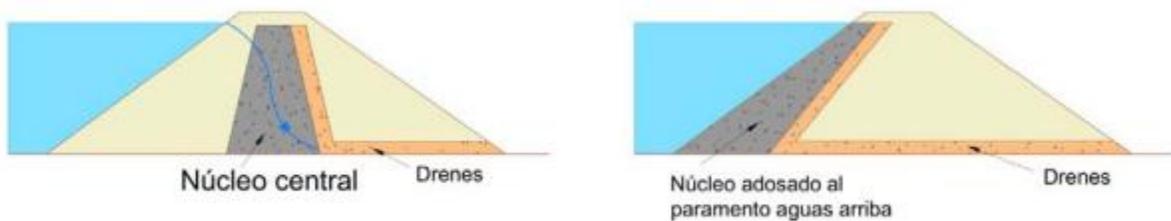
Presa zonadas con núcleo impermeable de arcilla.
